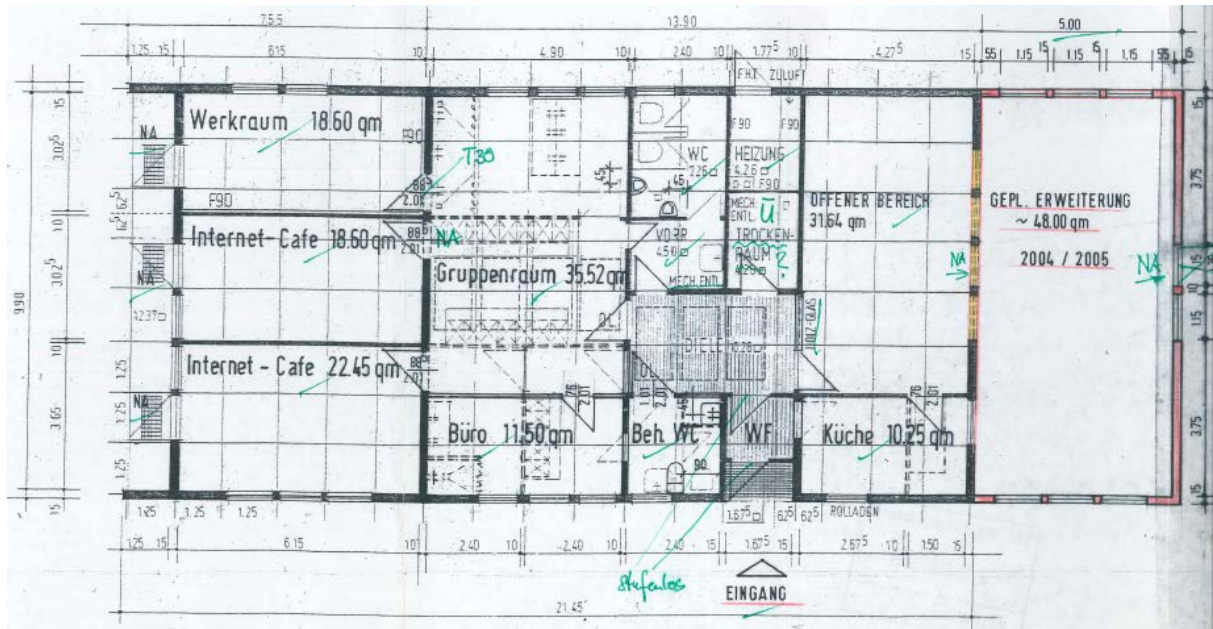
Grundriss mit geplanter Erweiterung, Stand 2004 | Quelle: Bezirksamt Reinickendorf, SE FM
